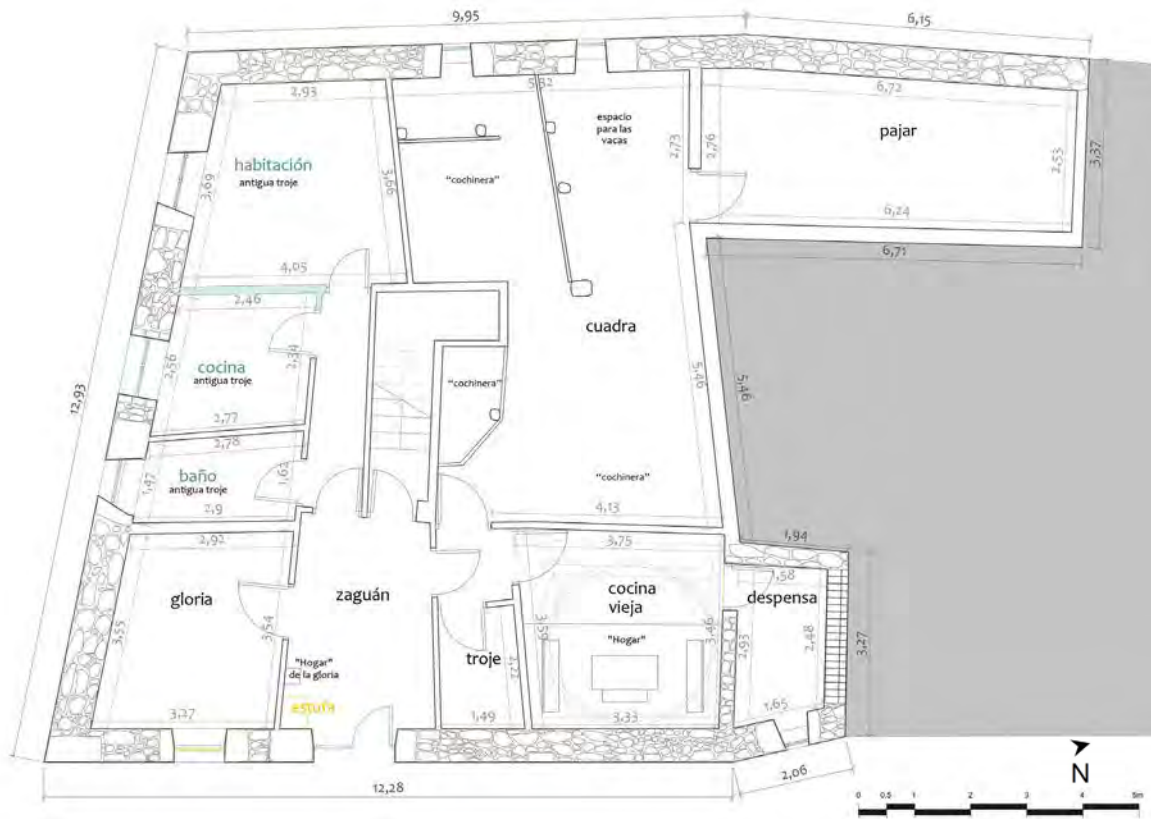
Planta baja vivienda caso de estudio.
